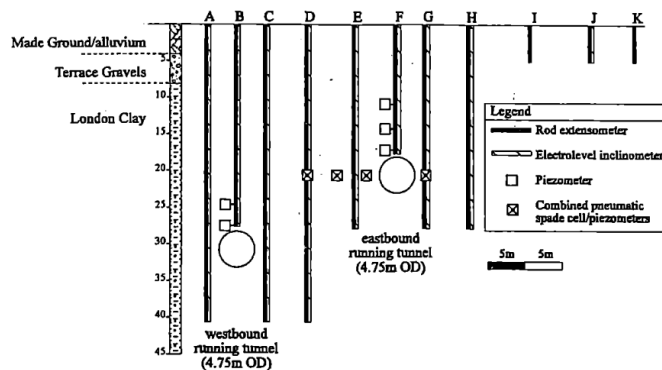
Section instrumentée St Jame's park – Standing et al., (1996)
